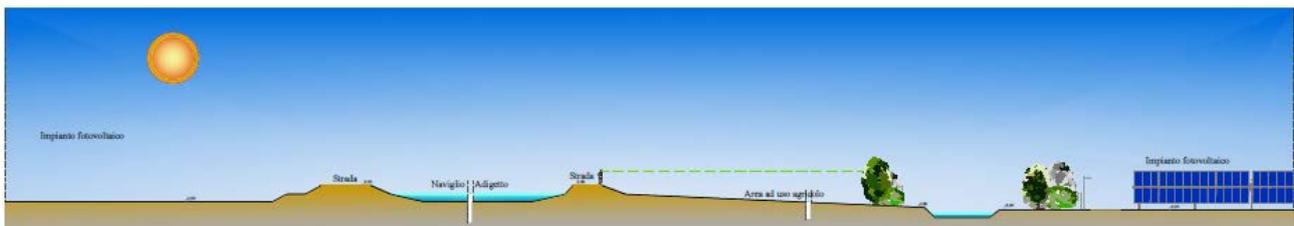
Sezione di intervisibilità dal punto di vista chiave n. 6 dal lato nord, dall'argine dx del ramo morto del Canalbianco (località Retinella)
